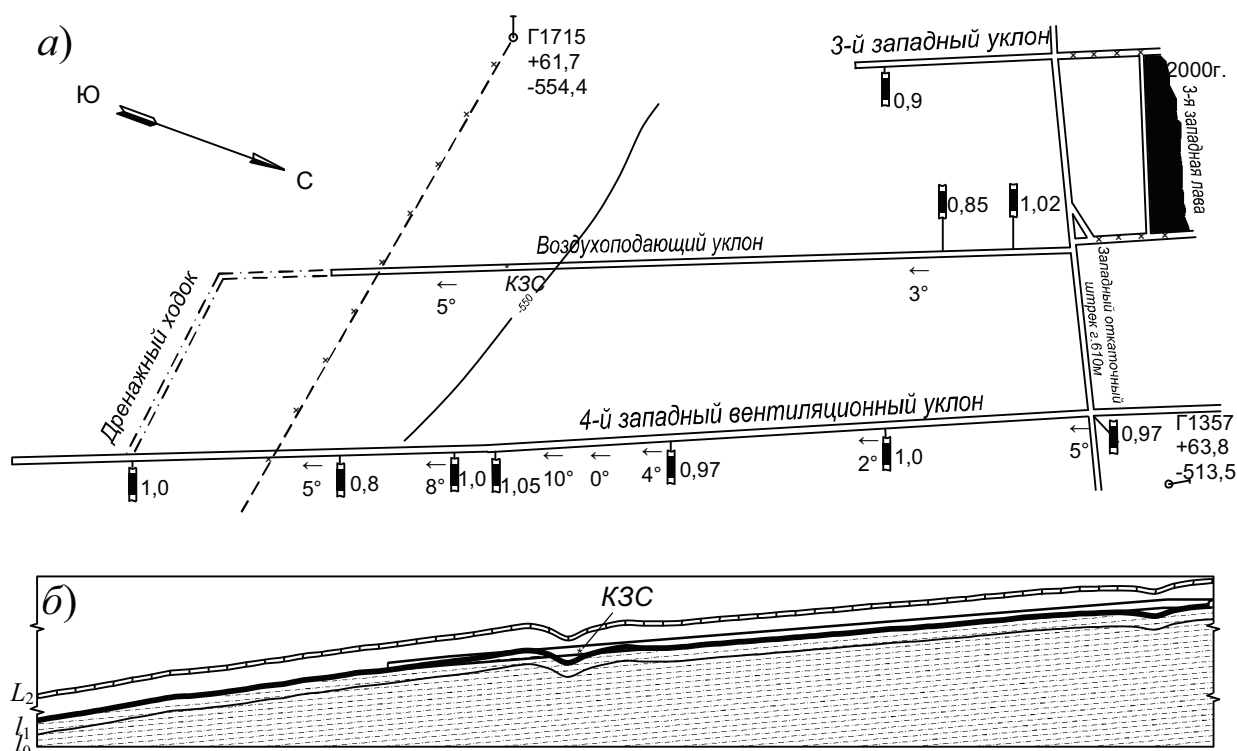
Выкопировка с плана горных работ (а) с указанием места расположения комплексной замерной станции (КЗС) и геологический разрез по воздухоподающему уклону
